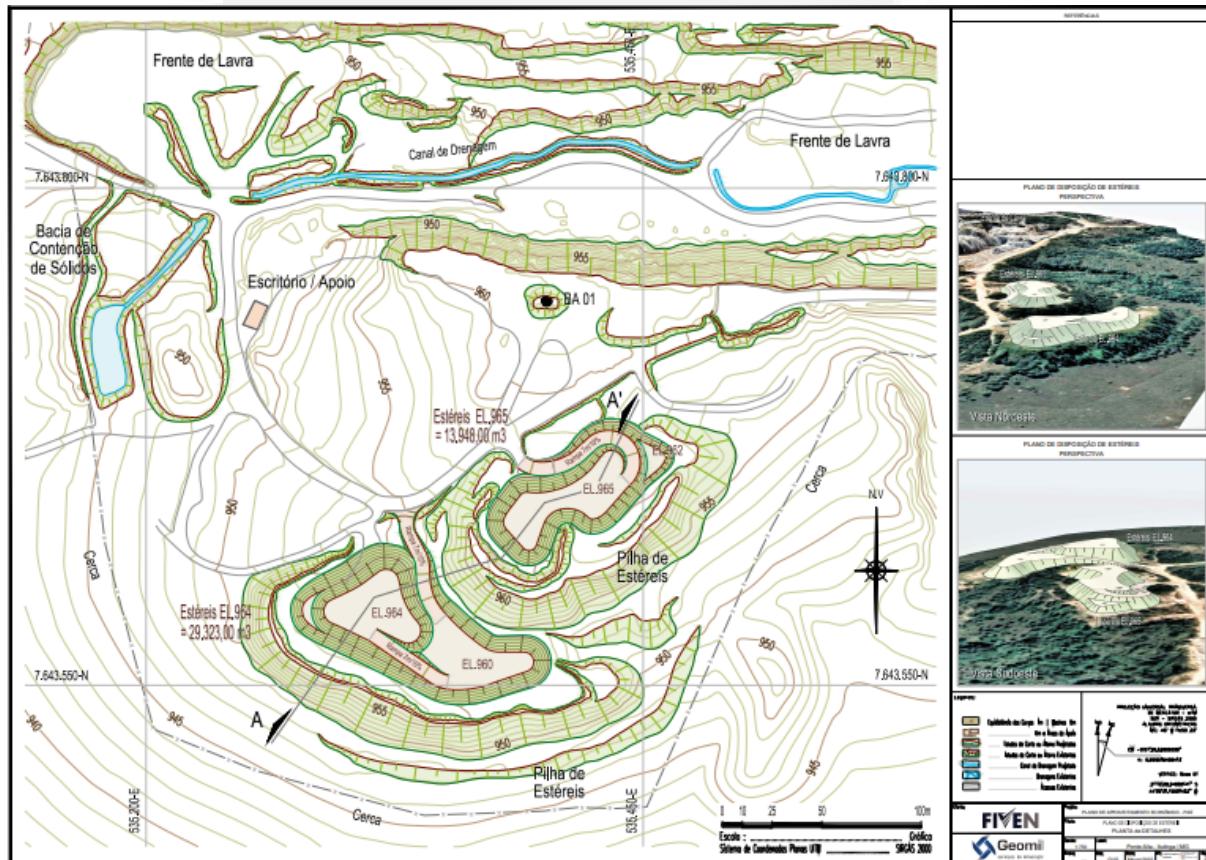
Planta da configuração após alteamento da pilha de estéril.
